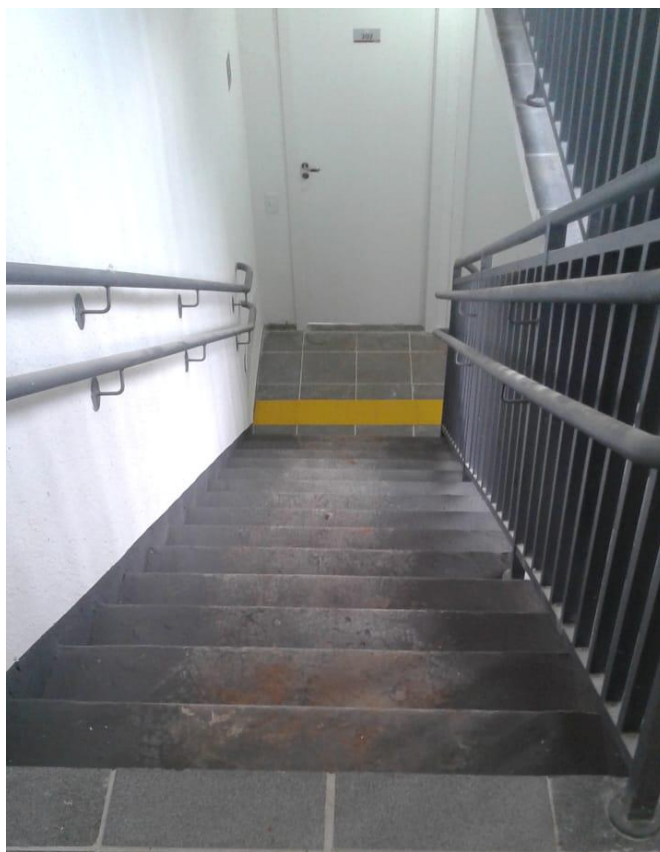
Hall entre o 2º e 3º pavimentos da torre. (Fonte: autora)
